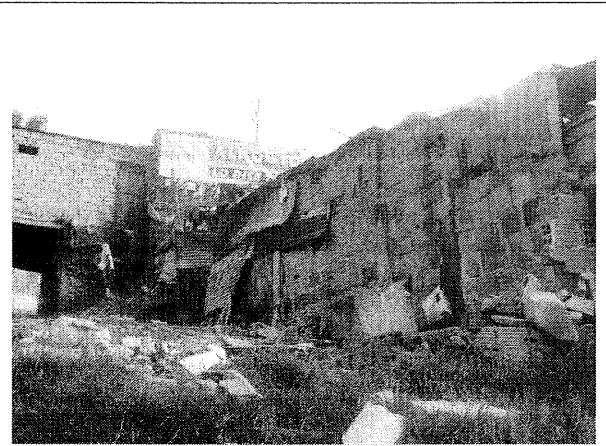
Costado sur de la vivienda, donde se evidencia la pérdida de verticalidad del muro del costado sur lo mismo que de la parte colapsada en el costado sur occidental de la vivienda.
